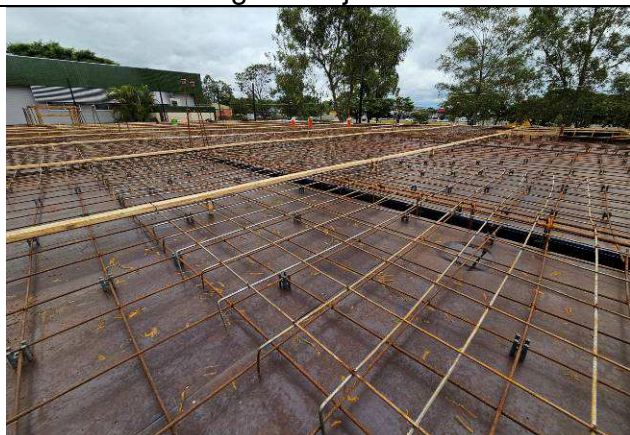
Formas e armaduras – vigas e lajes – 1º Pavimento.
